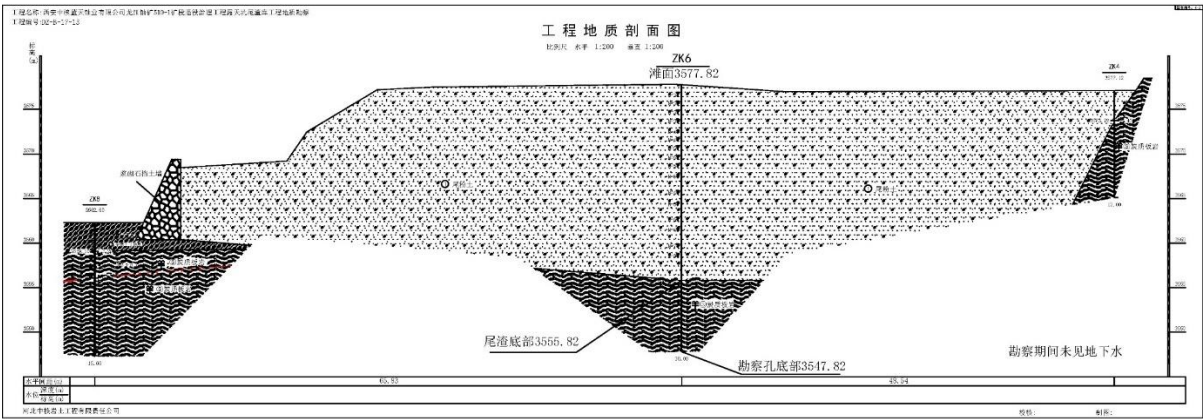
104 露天坑尾渣库工程勘察剖面图
